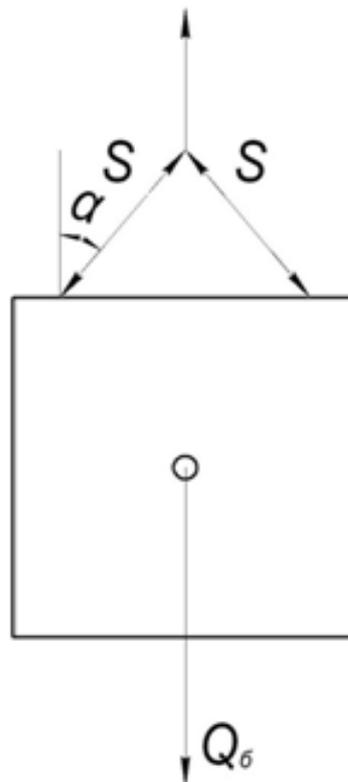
Розрахункова схема бункеру з бетонною сумішшю
